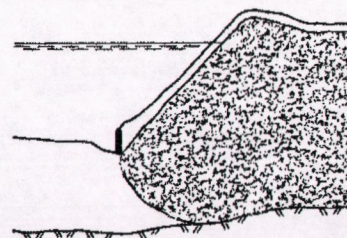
Utlegging av steinfylling med fortrenning av bløte masser.
